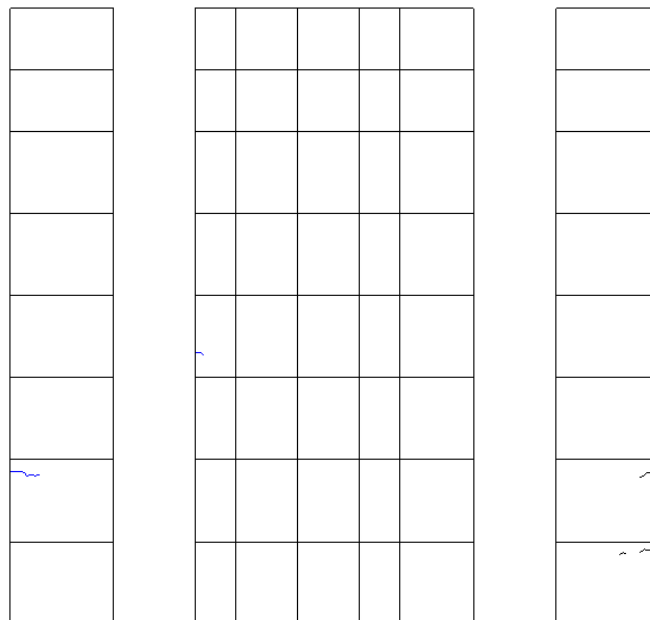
R=1/1600 ひび割れ図
